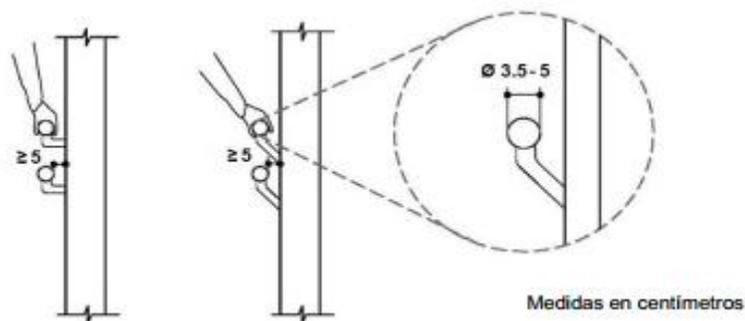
Vista en elevación frontal de dos variantes de una mano sujetando unos pasamanos
